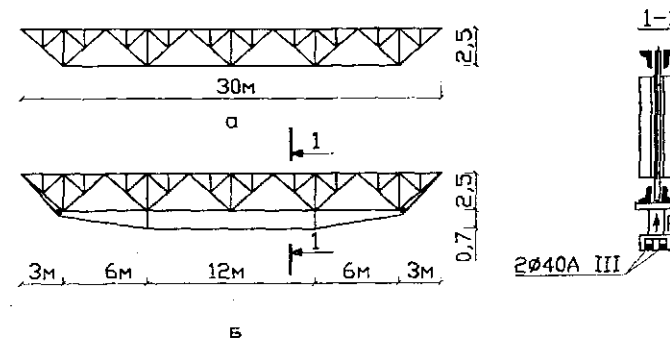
Усиление ферм покрытия шпренгелем: а — ферма до усиления; б — ферма усиленная шпренгелем
